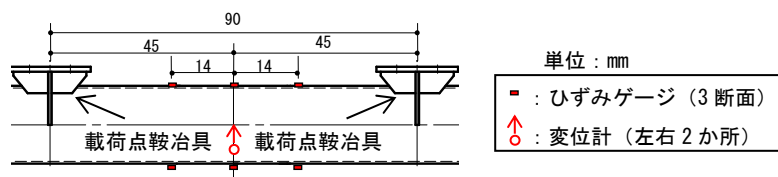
単調曲げ試験体の計器配置図 (例 : M-190S)
